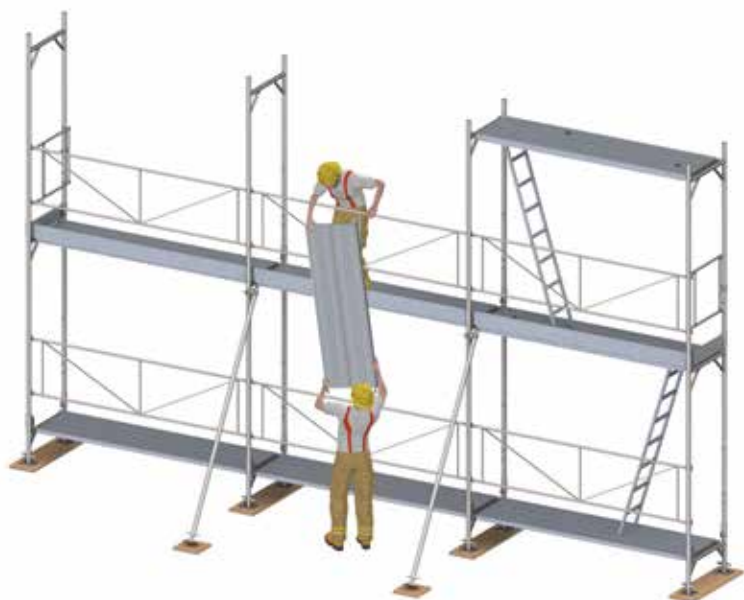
Exemple de soutènement provisoire du premier niveau d'échafaudage.
